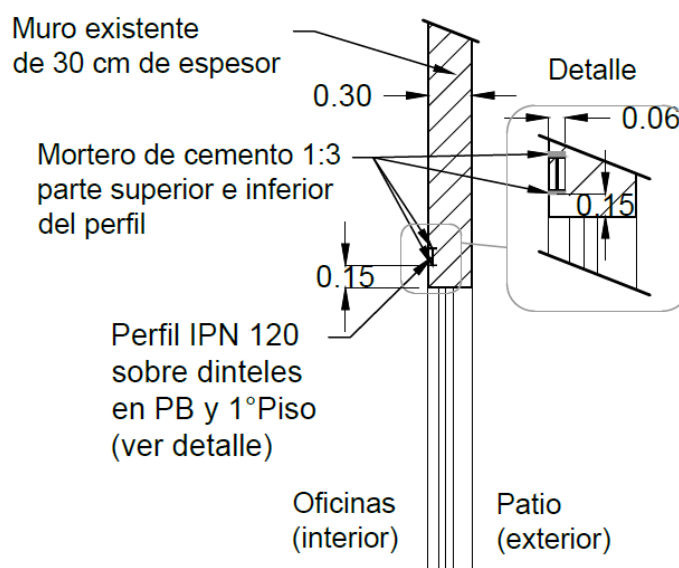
Detalle de los perfiles sobre las aberturas exteriores.
